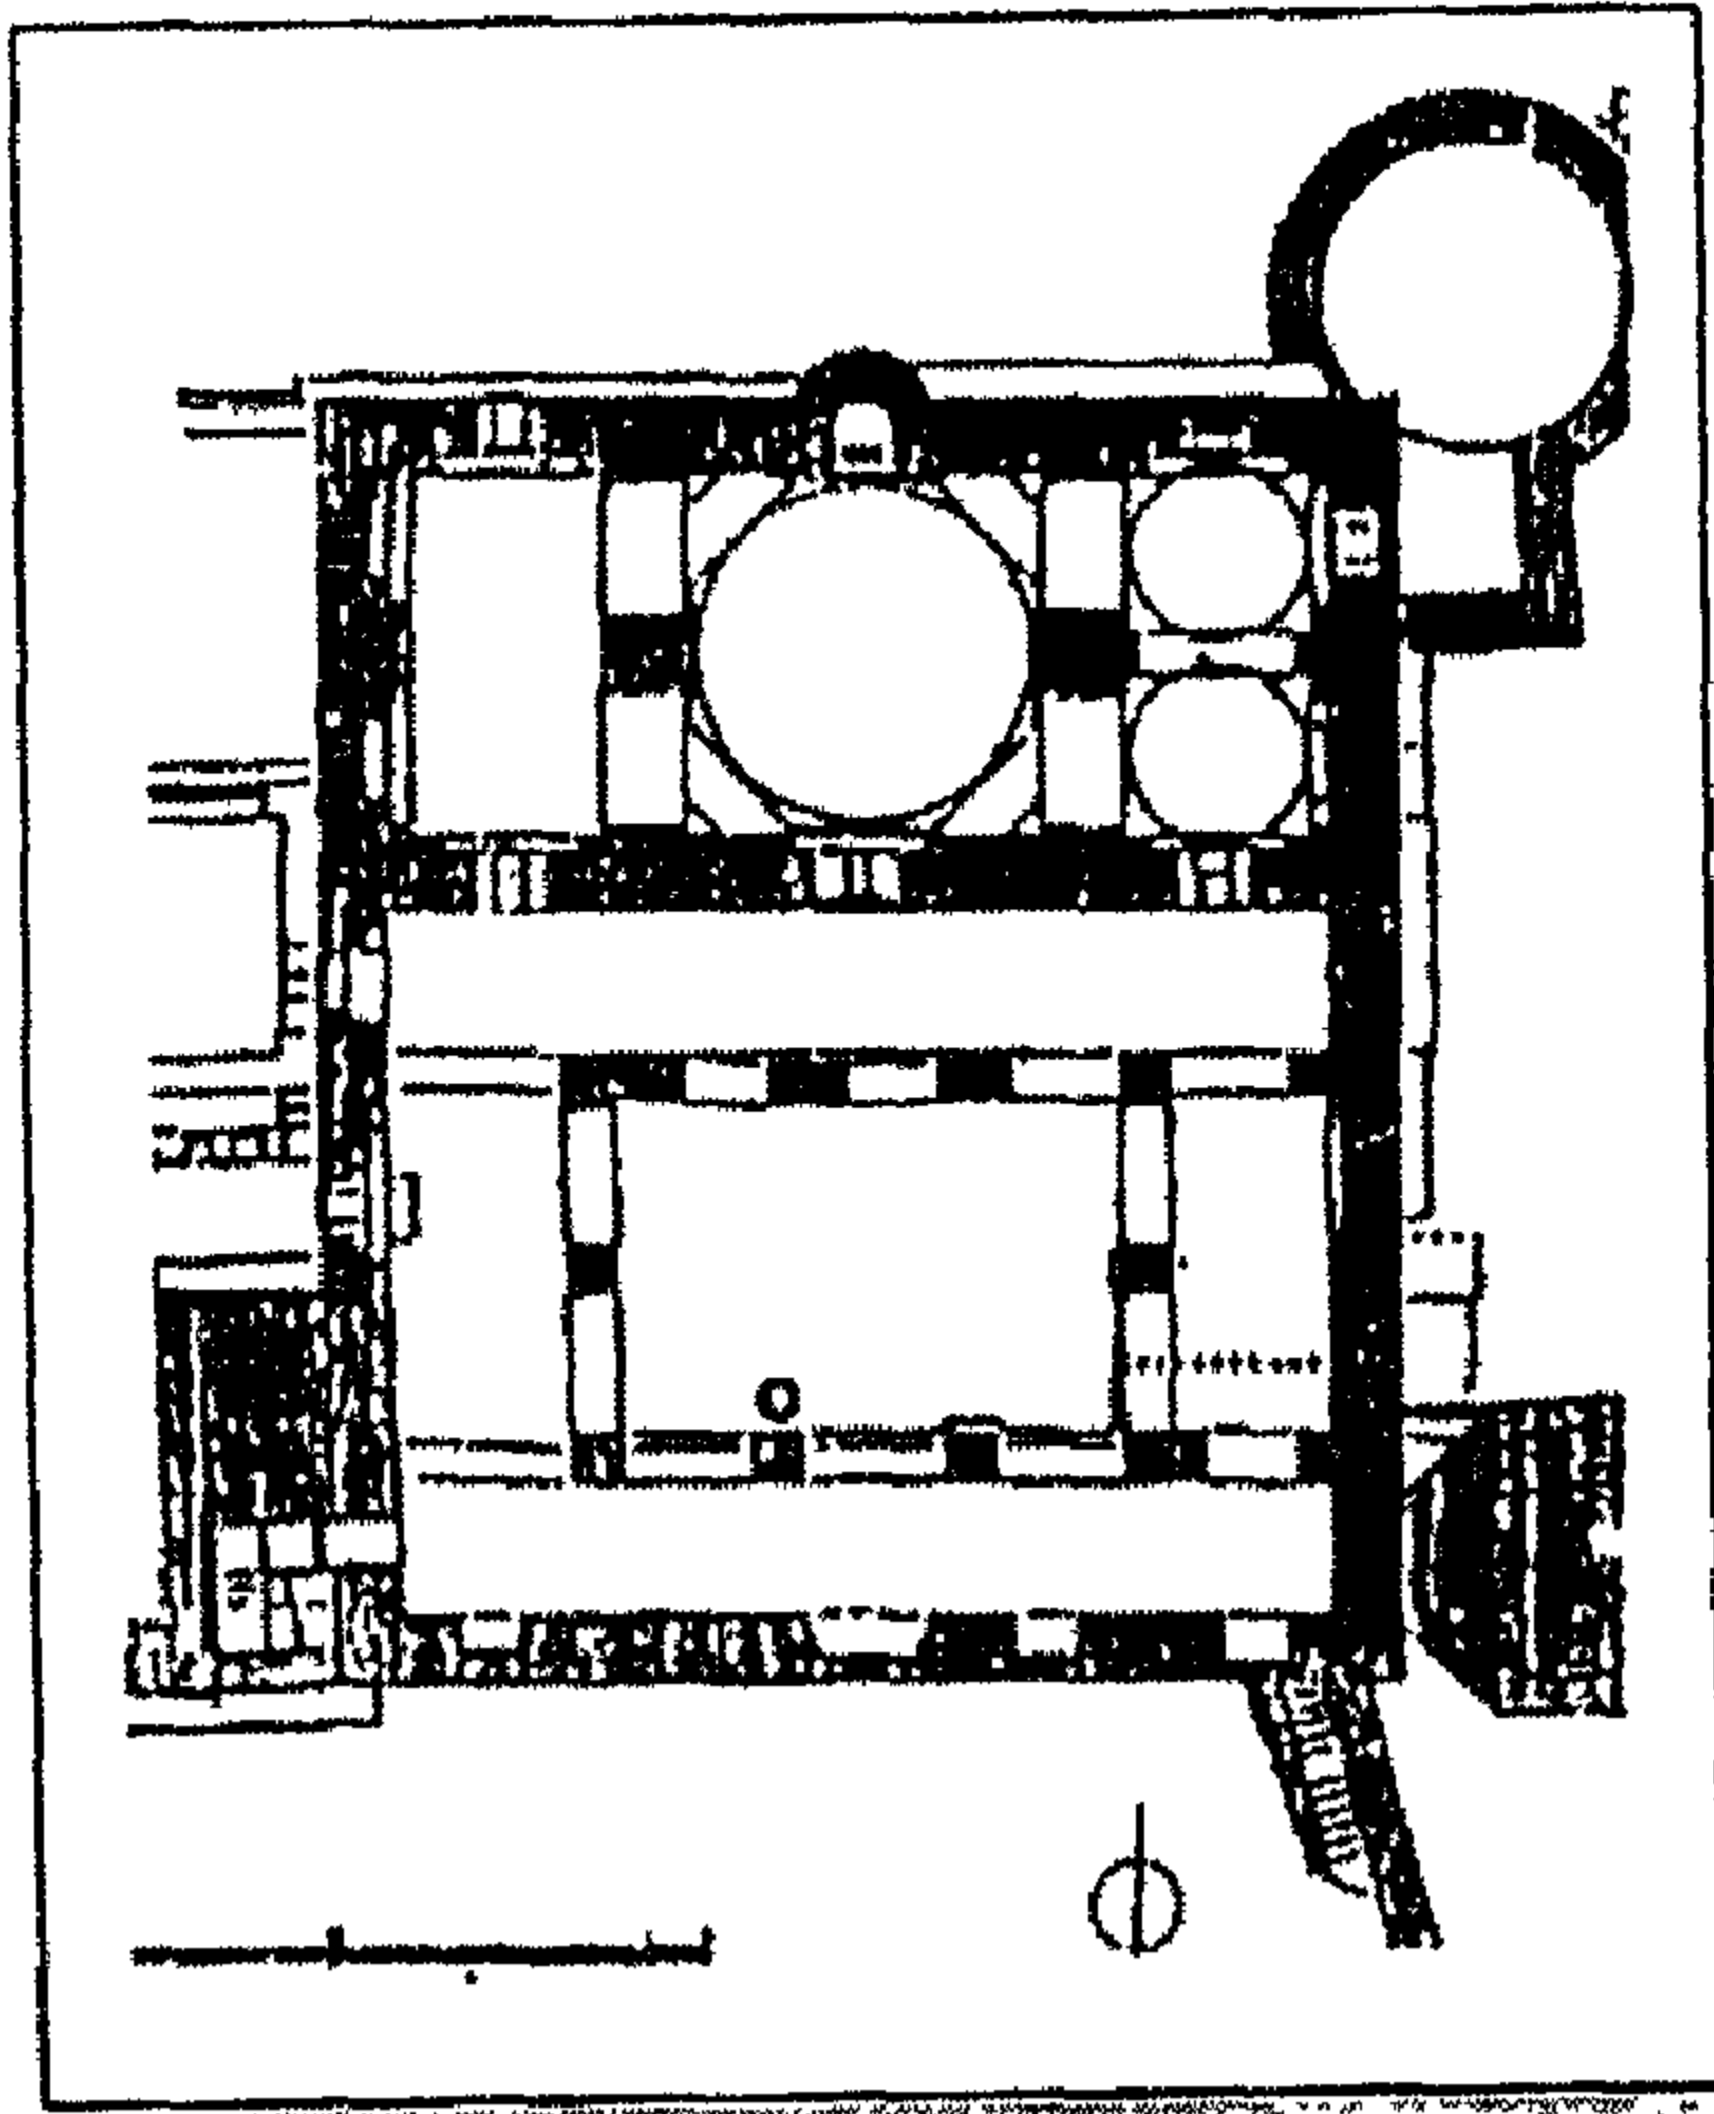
قبة وخانقاة السلطان (مسقط أفقي)
